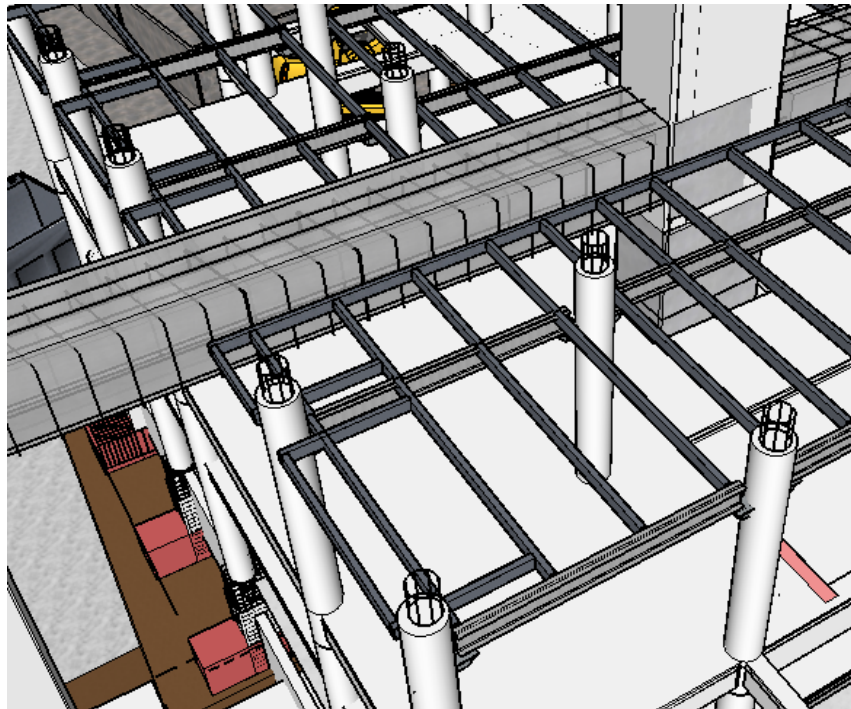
Render de instalación de vigas metálicas secundarias
